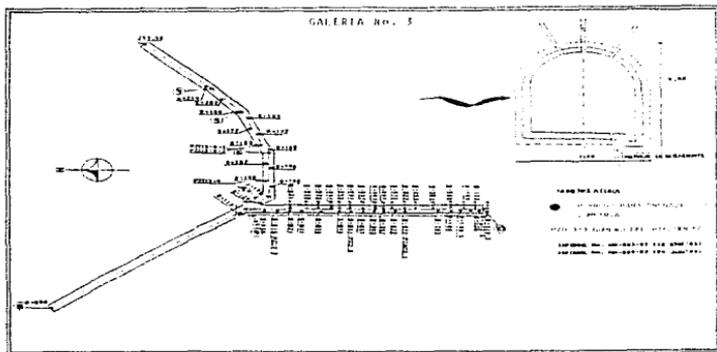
Pantalla de drenaje profundo y piezometría galería No 3
